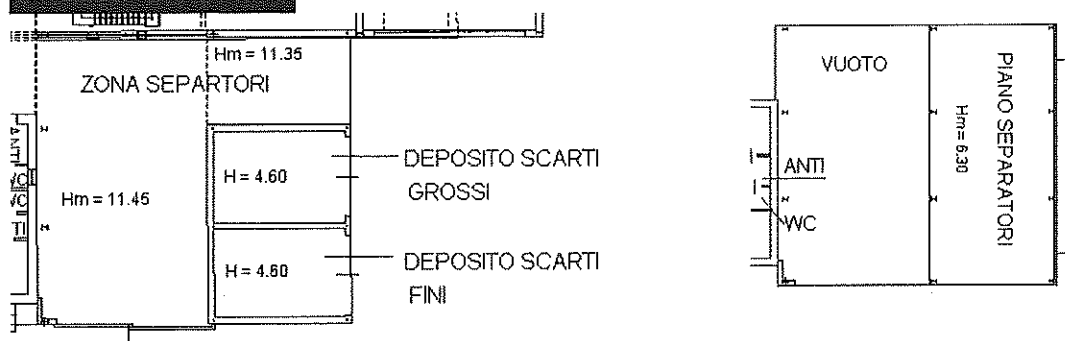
Estratto planimetria depositata presso l'archivio catastale (da sx a dx piano terra e primo)
